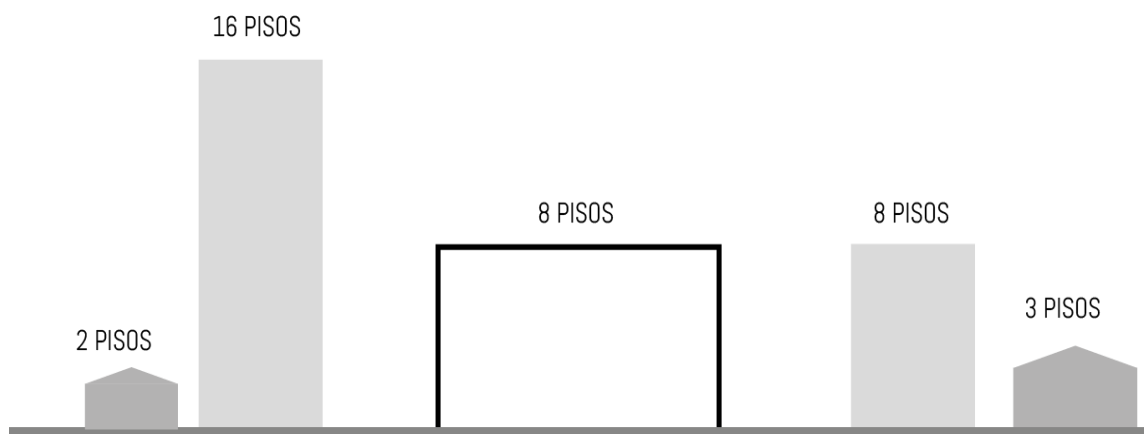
Planteamiento General del Proyecto (Vargas, 2017)
